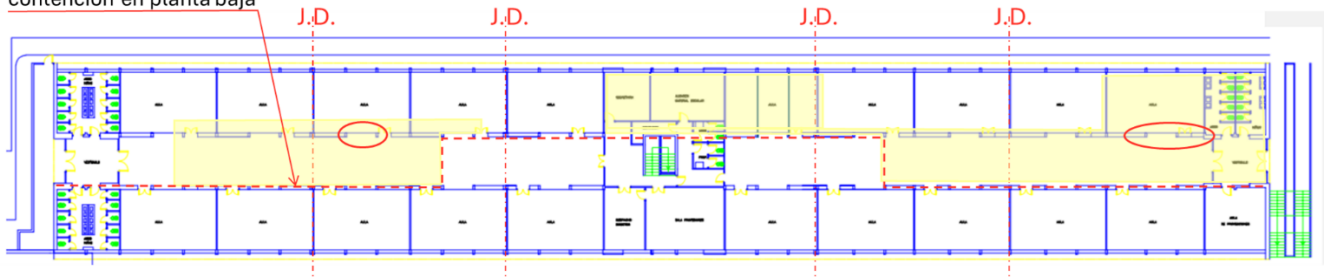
Indicios de cedimientos en pavimento sobre soleras en planta primera
